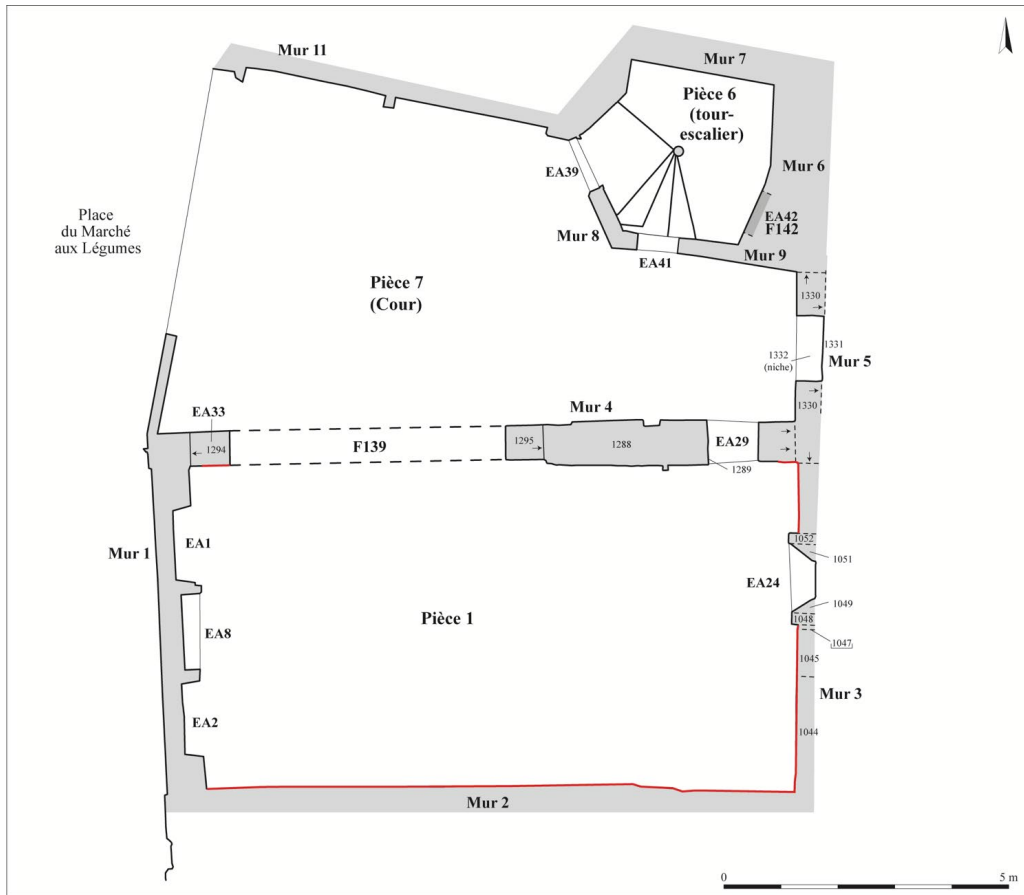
Plan du rez-de-chaussée avec les sondages, US et Faits principaux.
